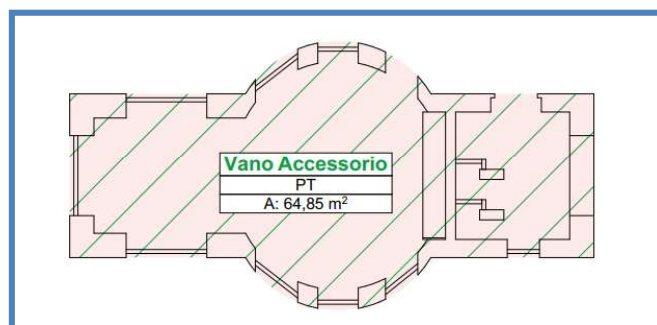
fabbricato sorgente - PIANTA PIANO TERRA
